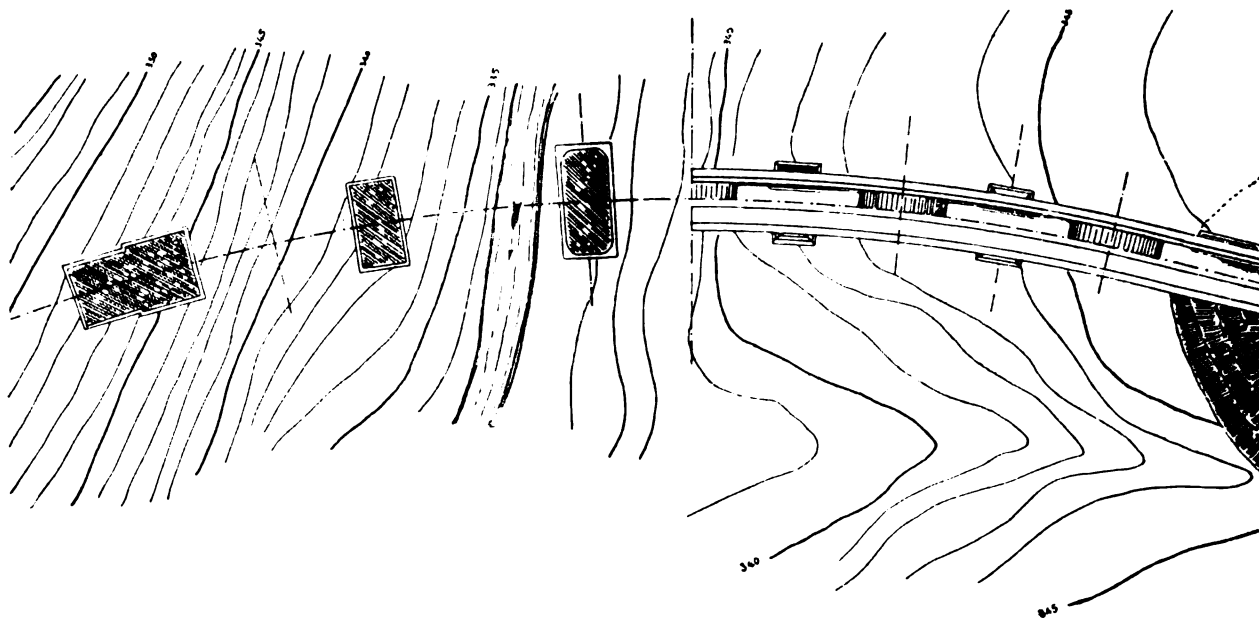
Viadotto della Selva. - Pianta al piano di fondazione, al piano delle cappe, ed al piano del ferro.
